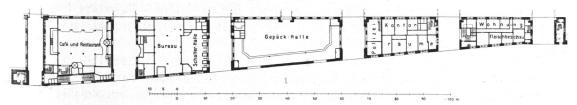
St. Pauli Landungsbrücken, Grundrif des Erdgeschosses.
